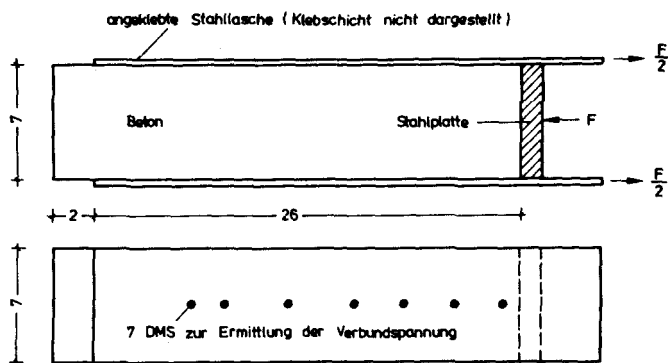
Betonkörper mit 2 aufgeklebten Stahllaschen /9/
